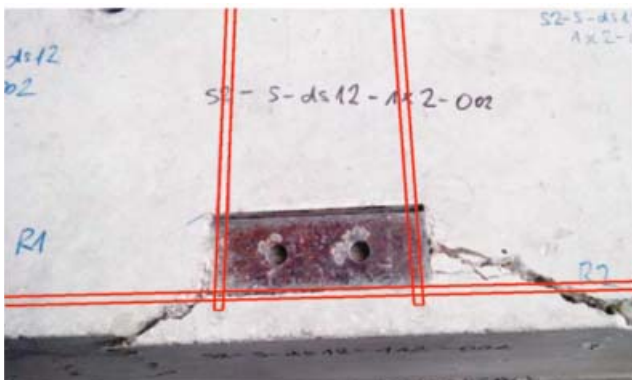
Typisches Bruchbild der Kopfbolzensgruppe 1x2 mit Rückhängebewehrung. Die Lage der Bügel und Randbewehrung ist durch rote Linien markiert.
